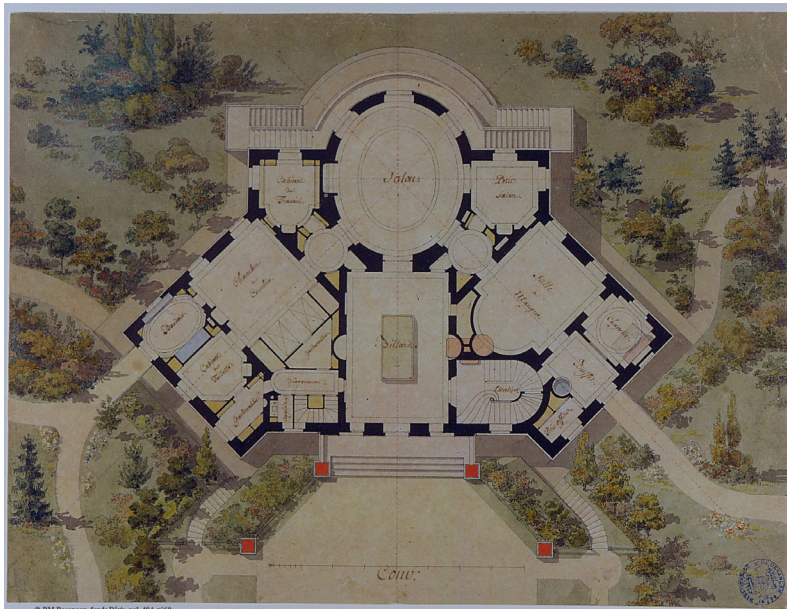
Pierre-Adrien Pâris, Plan du rez-de-chaussée du château de Colmoulin, BMB vol. 484 n° 60. © BM Besançon.
